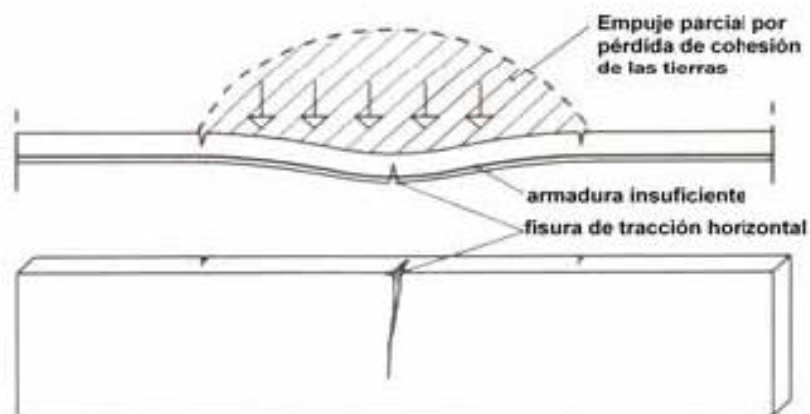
Fisuras por flexión simple, flexión compuesta y vigas pared.
